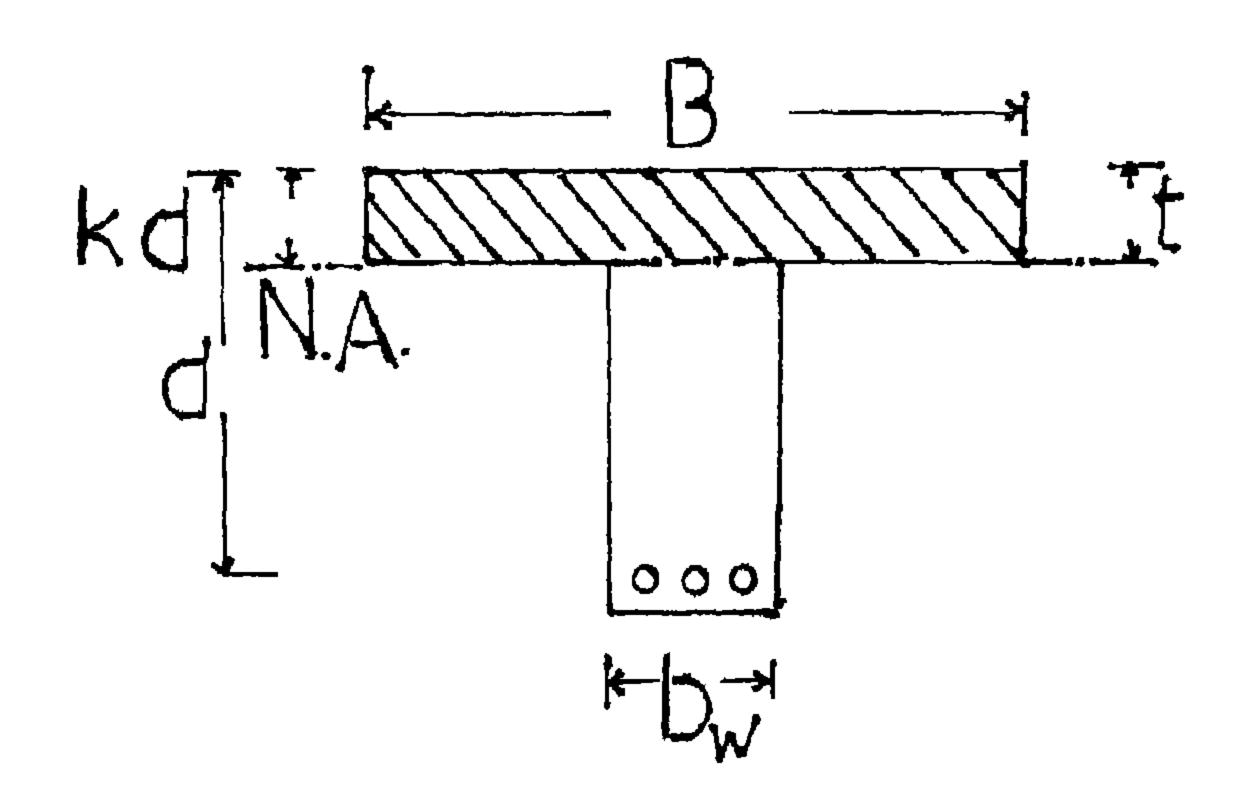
1) يوضح section في قطاع يحتوى على على عديد من الكمرات الخرسانية المسلحة
